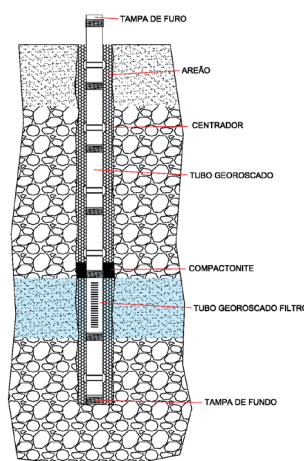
Representação esquemática do furo, após instalação da tubagem de revestimento Georoscado® e enchimento do espaço em torno da coluna com areia
